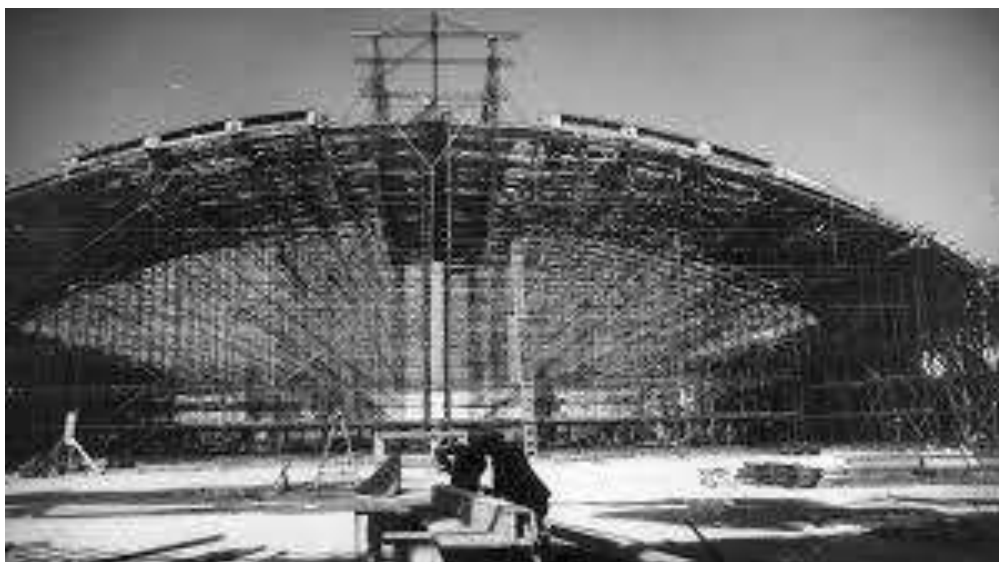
Sala de exposiciones de Turín, Italia, 1948. Bóveda bajo construcción, realizada con piezas tridimensionales prefabricadas.
